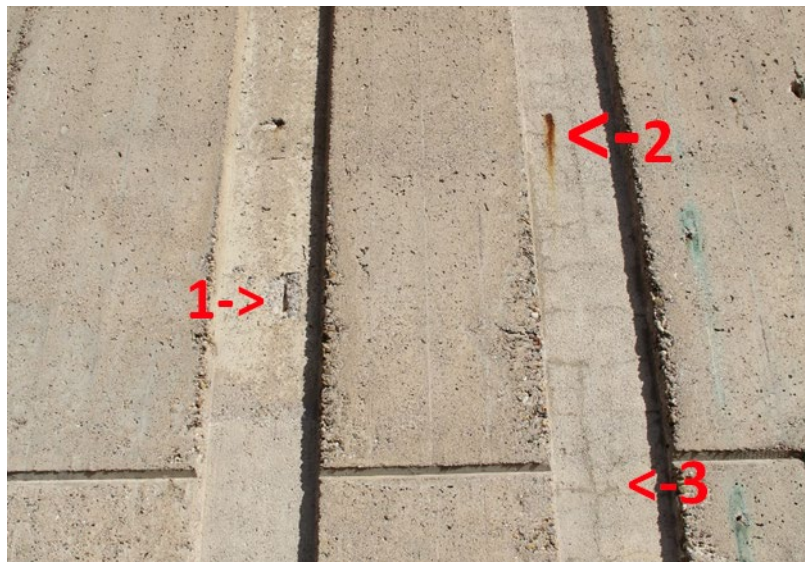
In den Vertiefungen finden sich geringfügige Schäden am Bestandsbeton: (1) Betonabplatzung über Bewehrung, (2) Rostfahne am Durchstoßpunkt eines freien Endes eines Bewehrungskorbs. Das Risskrakelee in der Bindemittelhaut (3) scheint stabil zu sein, es hat nicht zu Abplatzungen geführt.
